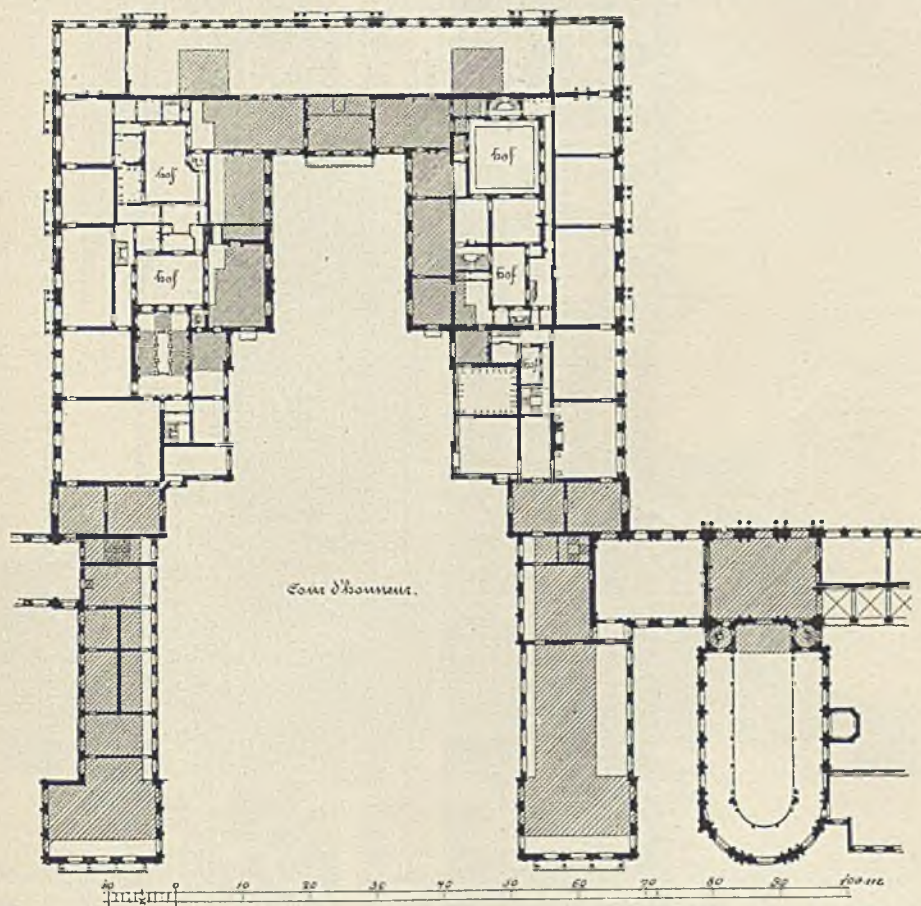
Plan des Mittelbaus des Schlosses zu Versailles
